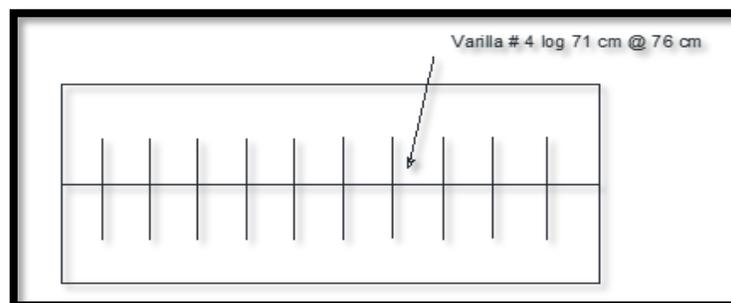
Juntas longitudinales para pavimento rígido.
